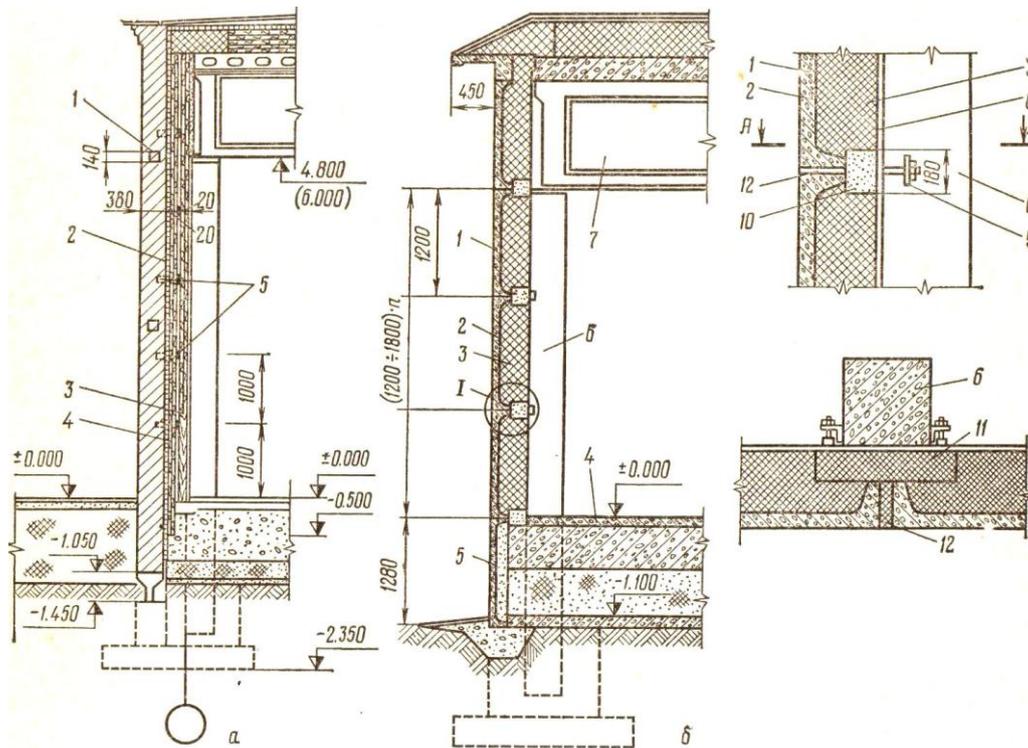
Фасады и конструкции наружных стен из сборных горизонтальных и вертикальных панелей одноэтажных (а) и многоэтажных (б) холодильников
